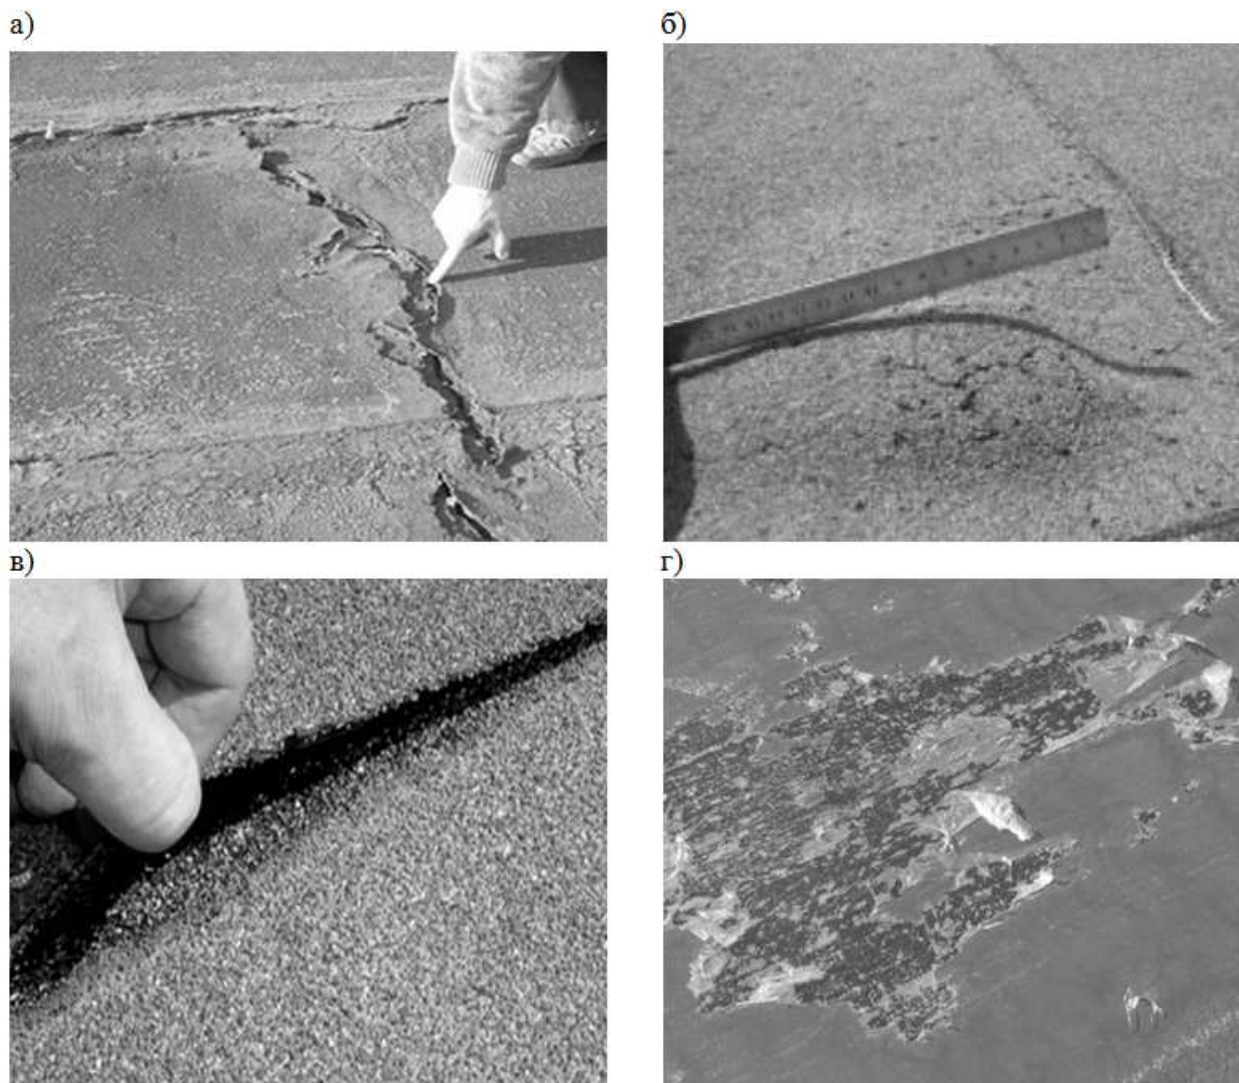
Характерные дефекты и повреждения кровли из рулонных наплавляемых материалов: а) сквозная трещина; б) вздутие; в) нарушение водонепроницаемости; г) нарушение исходной структуры материала.
